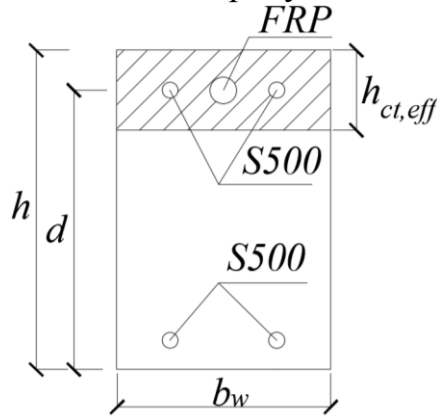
Схема разбиения железобетонного элемента на подэлементы
